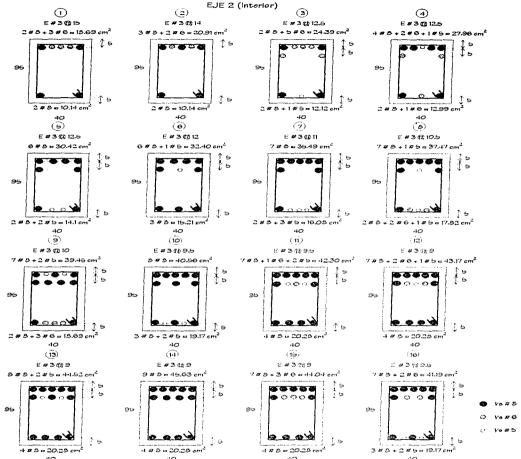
Comparación de cuantías de acero de refuerzo longitudinal de las vigas del eje 2 de las estructuras discriadas en las zonas :: y ::
